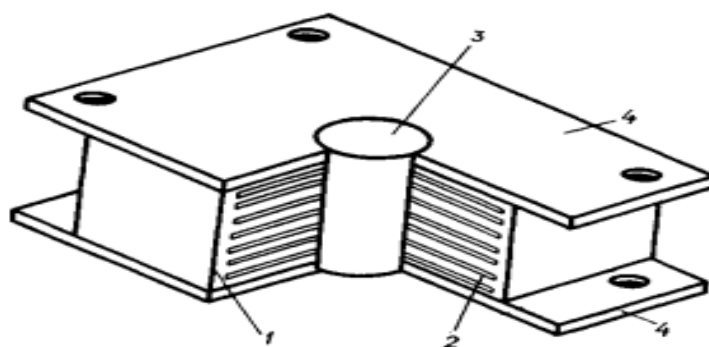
Конструктивная схема резинометаллической опоры со свинцовым сердечником (Новая Зеландия): 1 – каучук (резина); 2 – внутренний стальной лист; 3 – свинцовый сердечник; 4 – опорный стальной лист.
